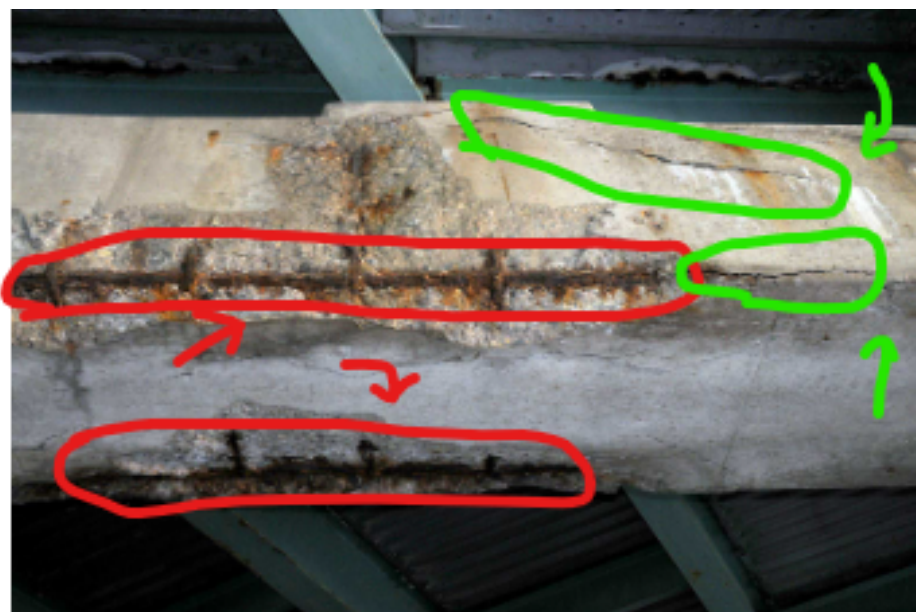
Corrosão de armadura longitudinal por íons de cloreto apresentado por destaque vermelho e fissuras de deslocamento com destaque verde.
